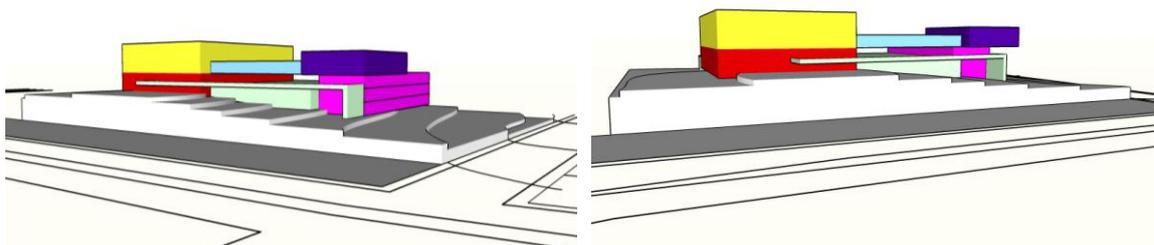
e 167: Estudo de volumetria do projeto conforme zoneamento.
